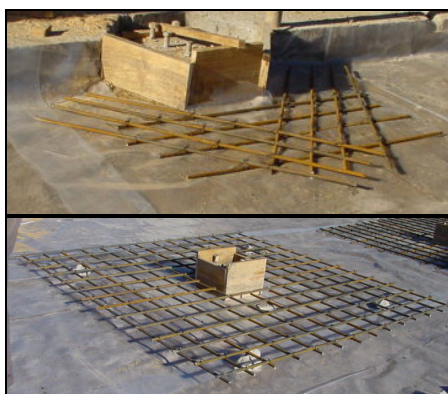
Pormenores de reforço nos pavimentos de BRFA.
